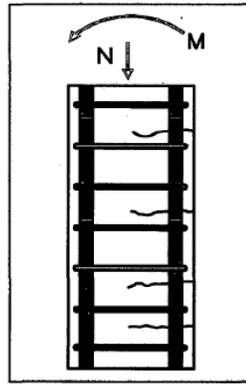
Esquemas de fisuración de una columna sometida a Flexión compuesta con excentricidad
